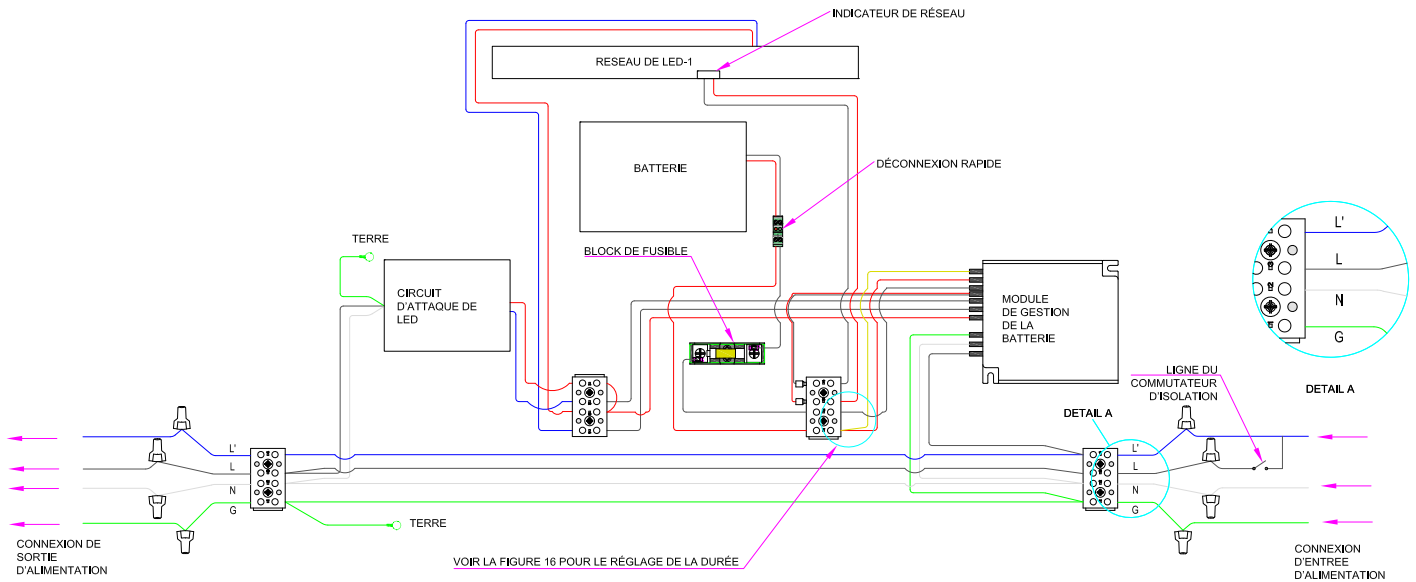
A: CABLAGE D'ALIMENTATION CONTINUE, DISPOSITION DE CONNEXION A 4 FILS AVEC ECROUS DE FIL: 2 PIEDS
